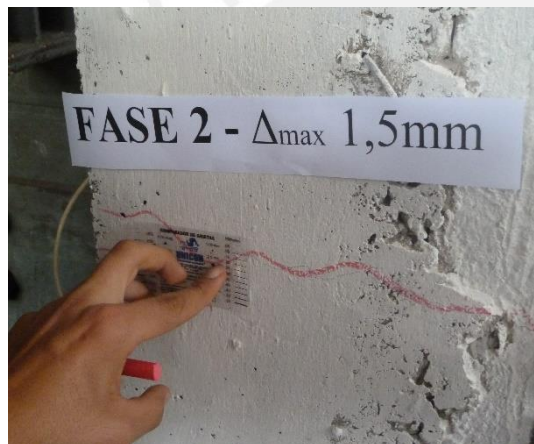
Fase 2: Primeras fisuras en parte inferior de columnas.
